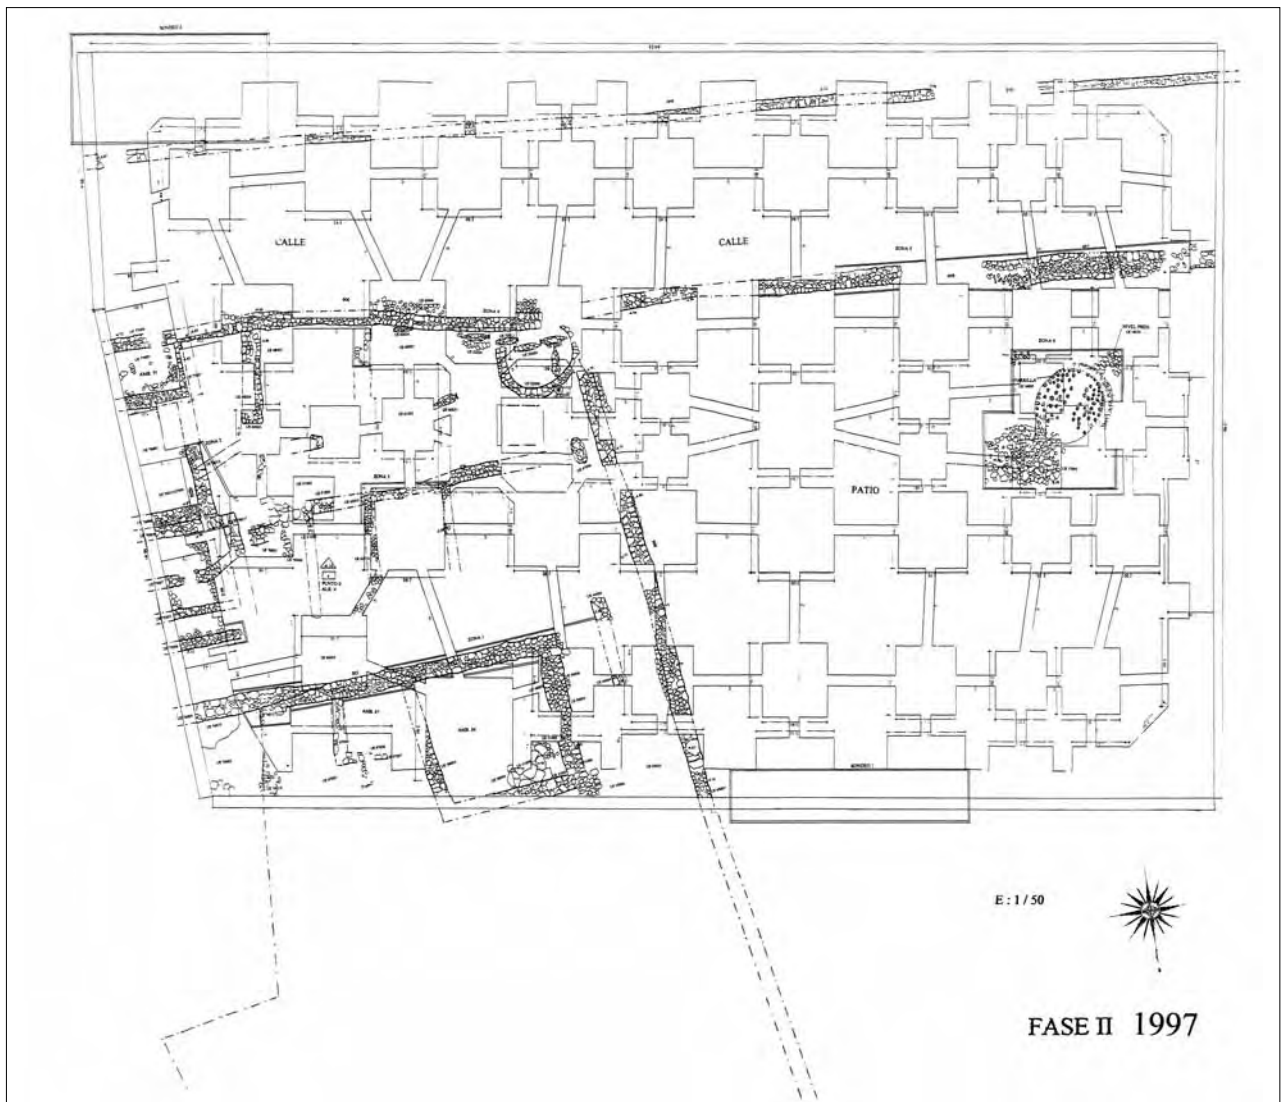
Planta general de las estructuras documentadas en la excavación arqueológica realizada en el solar del edificio Alberca VI.
